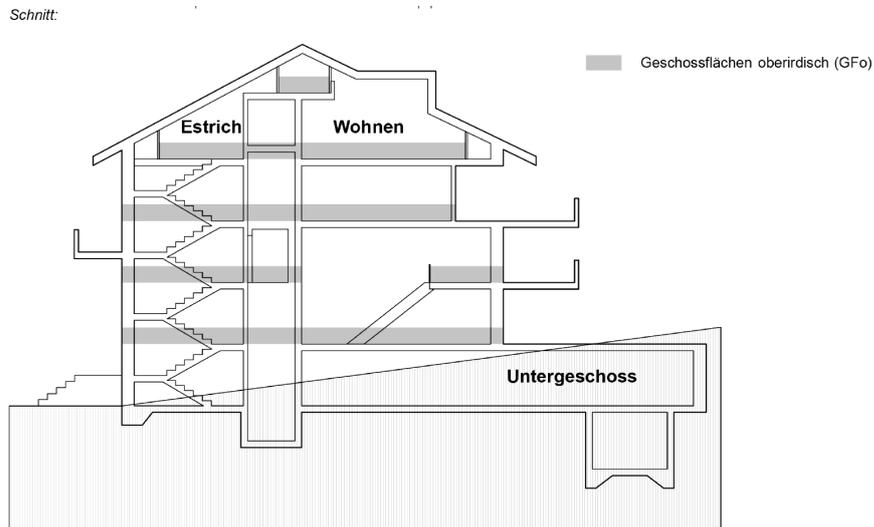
Skizze zu den Geschossflächen oberirdisch (GFo)
